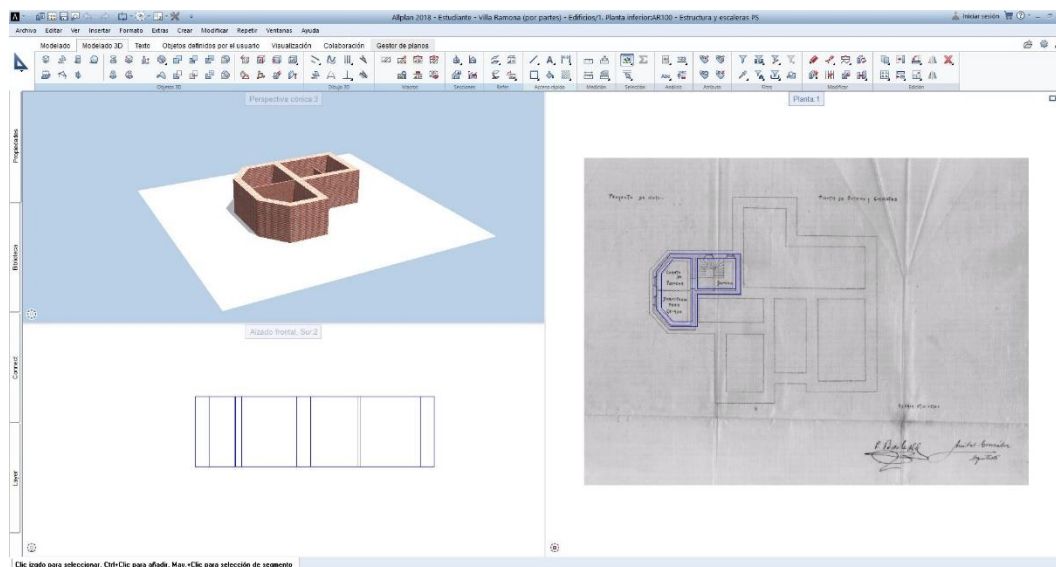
Generación planta semisótano. Elementos constructivos generales Allplan 2018. Fuente: Elaboración propia
